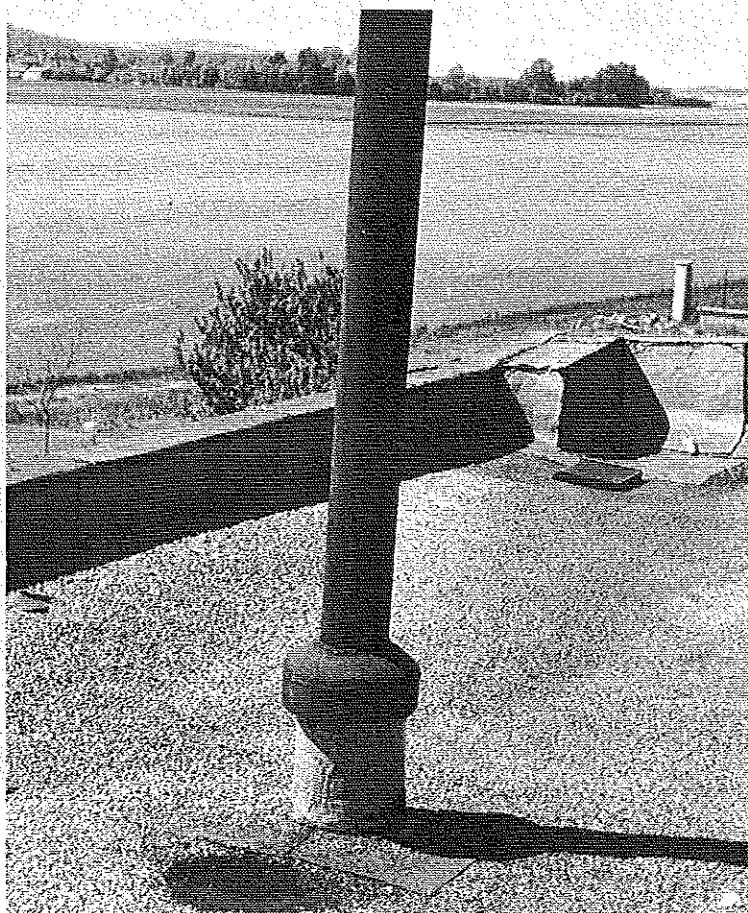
Altération caractérisée par destruction localisée du revêtement d'étanchéité au droit d'une ventilation de locaux industriels.
